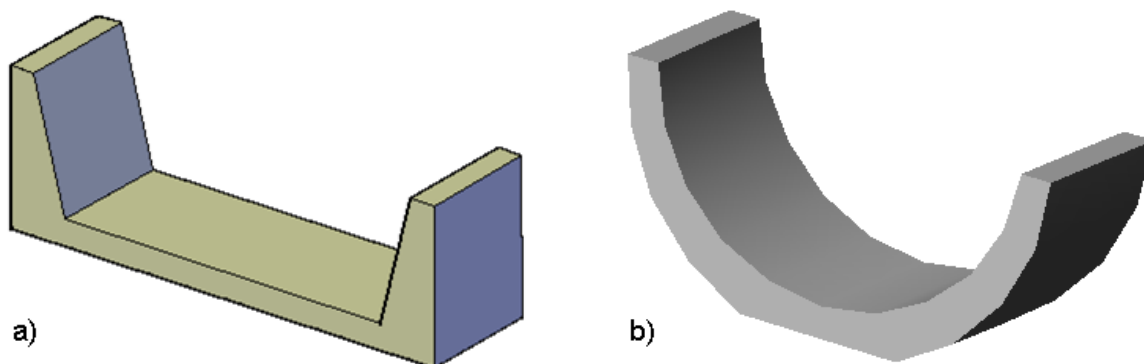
Travessas em concreto armado para as opções 1 (a) e 2 (b) de seção das vigas.
